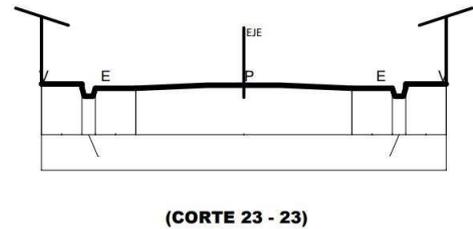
PLANO DE PROPUESTA VIAL
